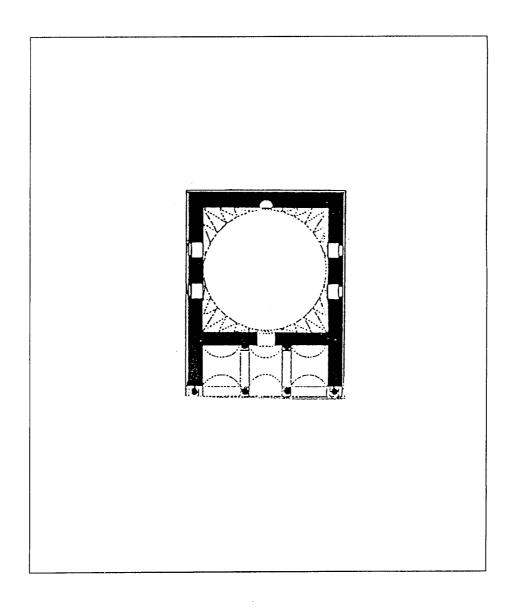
مسقط أفقي لمسجد حسن بالى زاده في الباسان (عن : كيل) .
